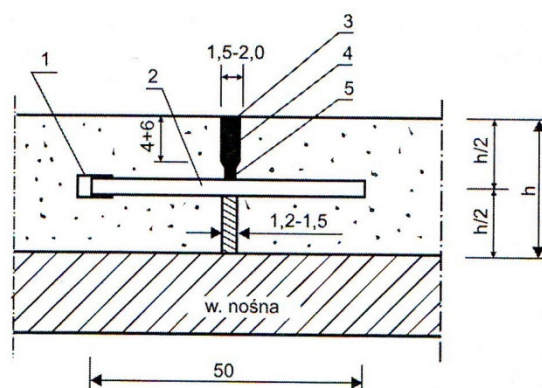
Przykładowy przekrój posadzki (dodatkowo zazbrojony) w miejscu ułożenia przewodów. Źródło własne
